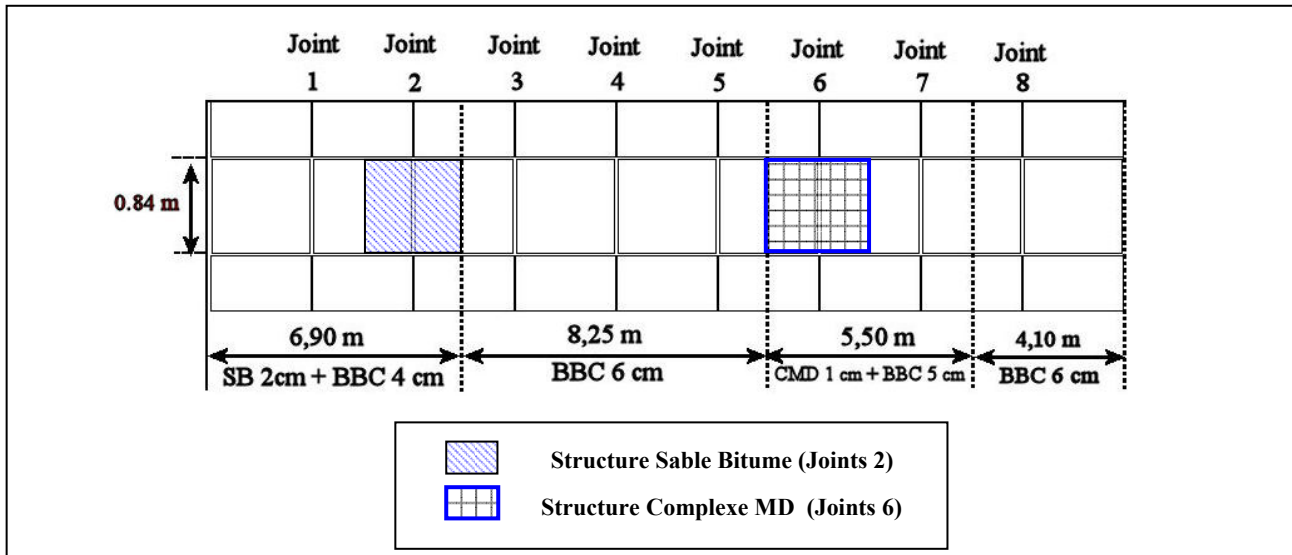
Disposition des structures par joint établie sur les dalles de la piste FABAC pour l'essai de fissuration
